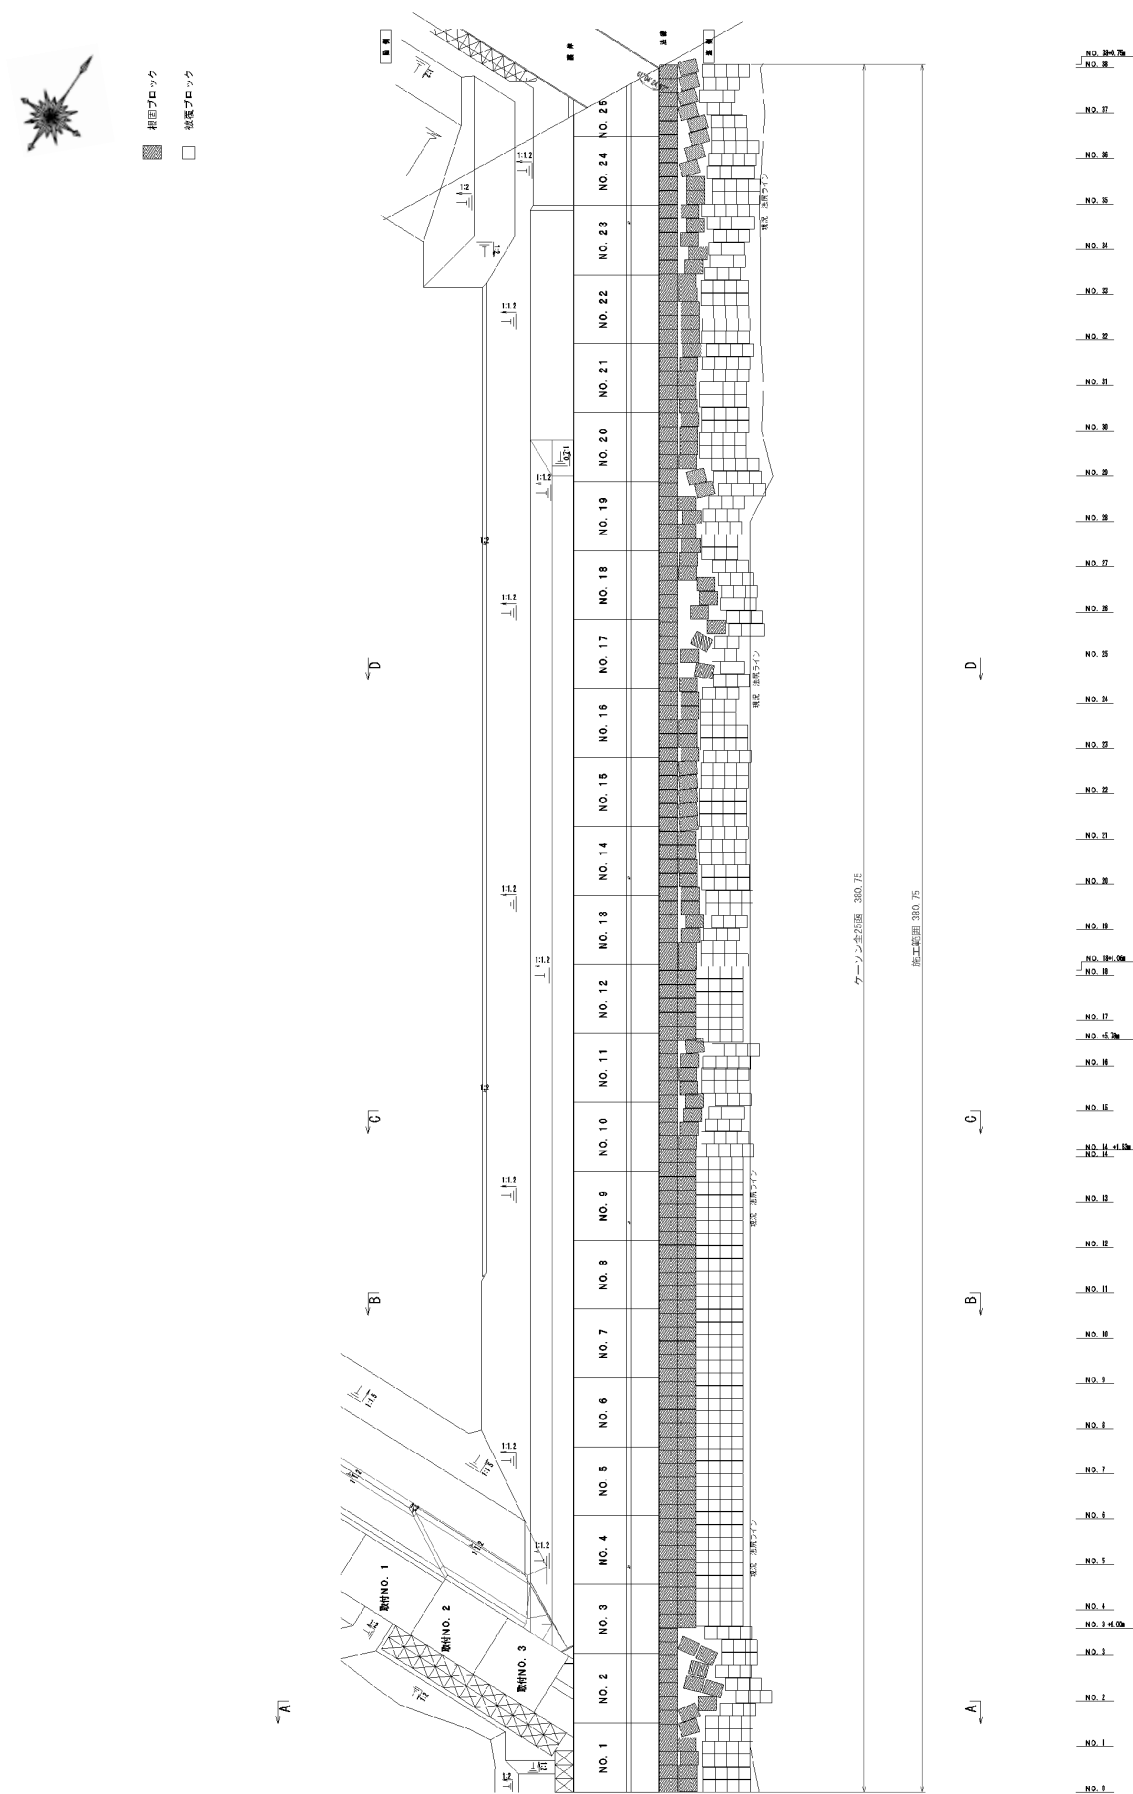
No.1 外港地区防波護岸現況図(被災後)
